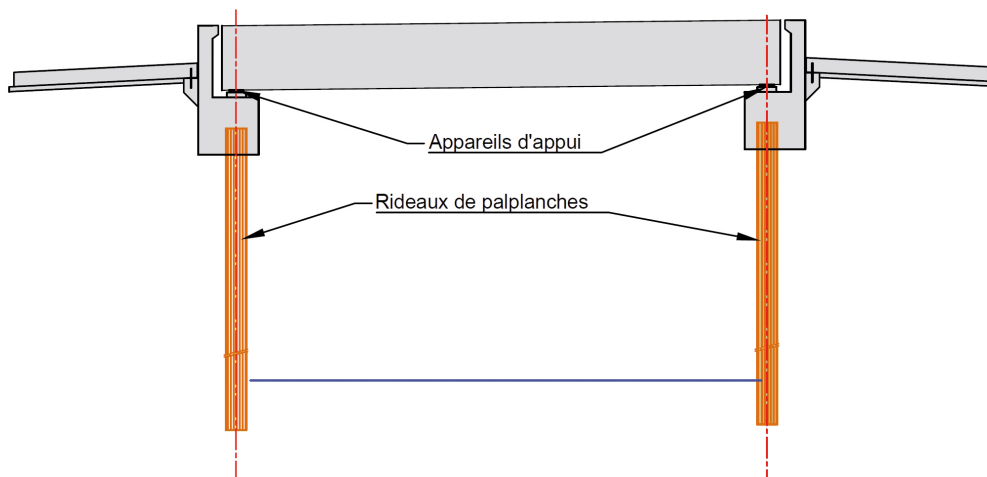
Ouvrage sur palplanches muni d'appareils d'appui sur la D365 à Quimper
